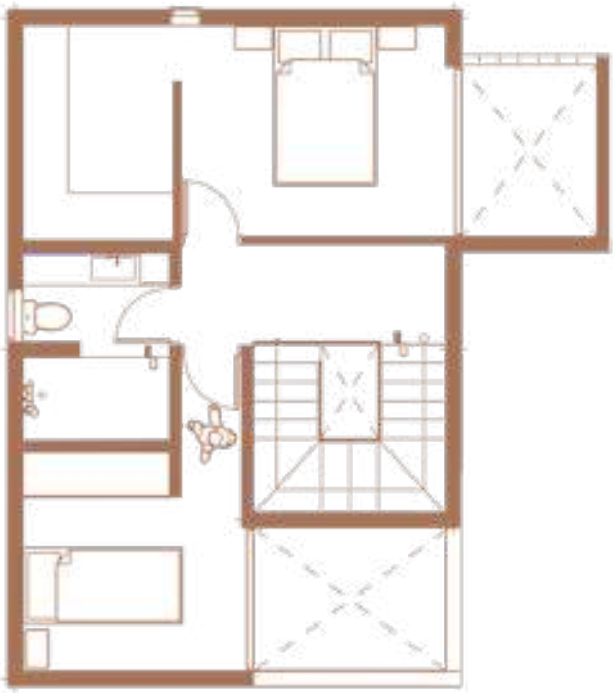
NIVEL 02 - Planta. Departamento 02.
